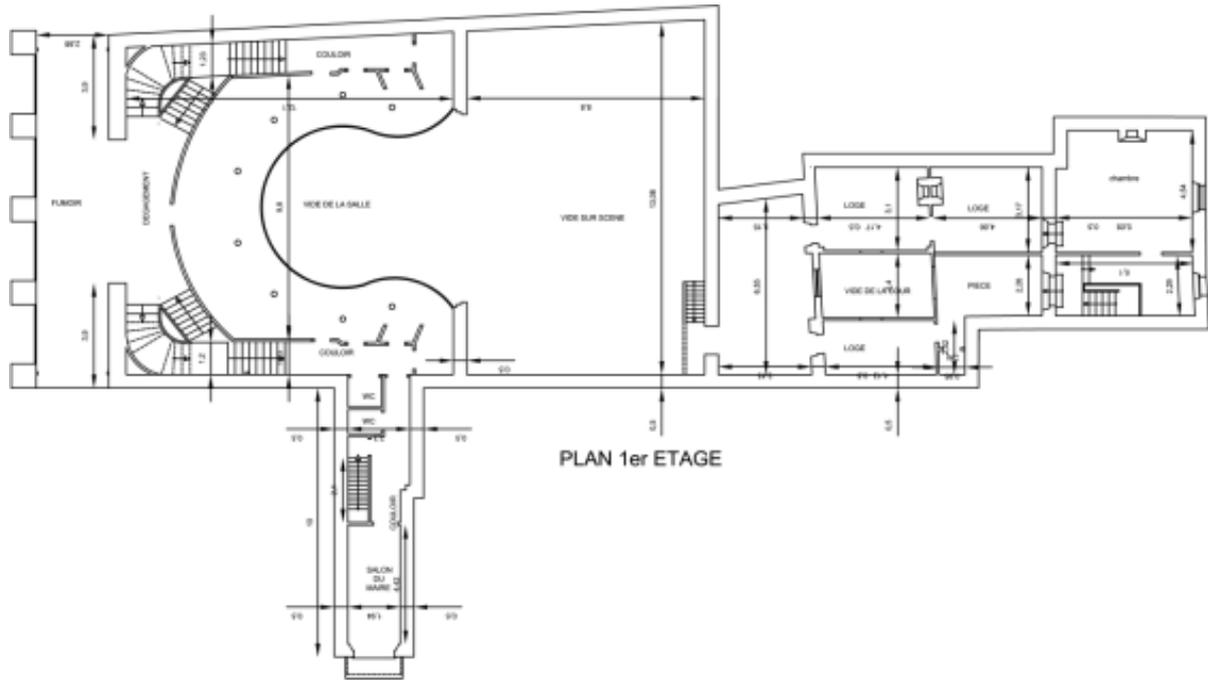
plan de premier balcon du théâtre municipal de Blida 1852/1853, (les archives de la mairie).
